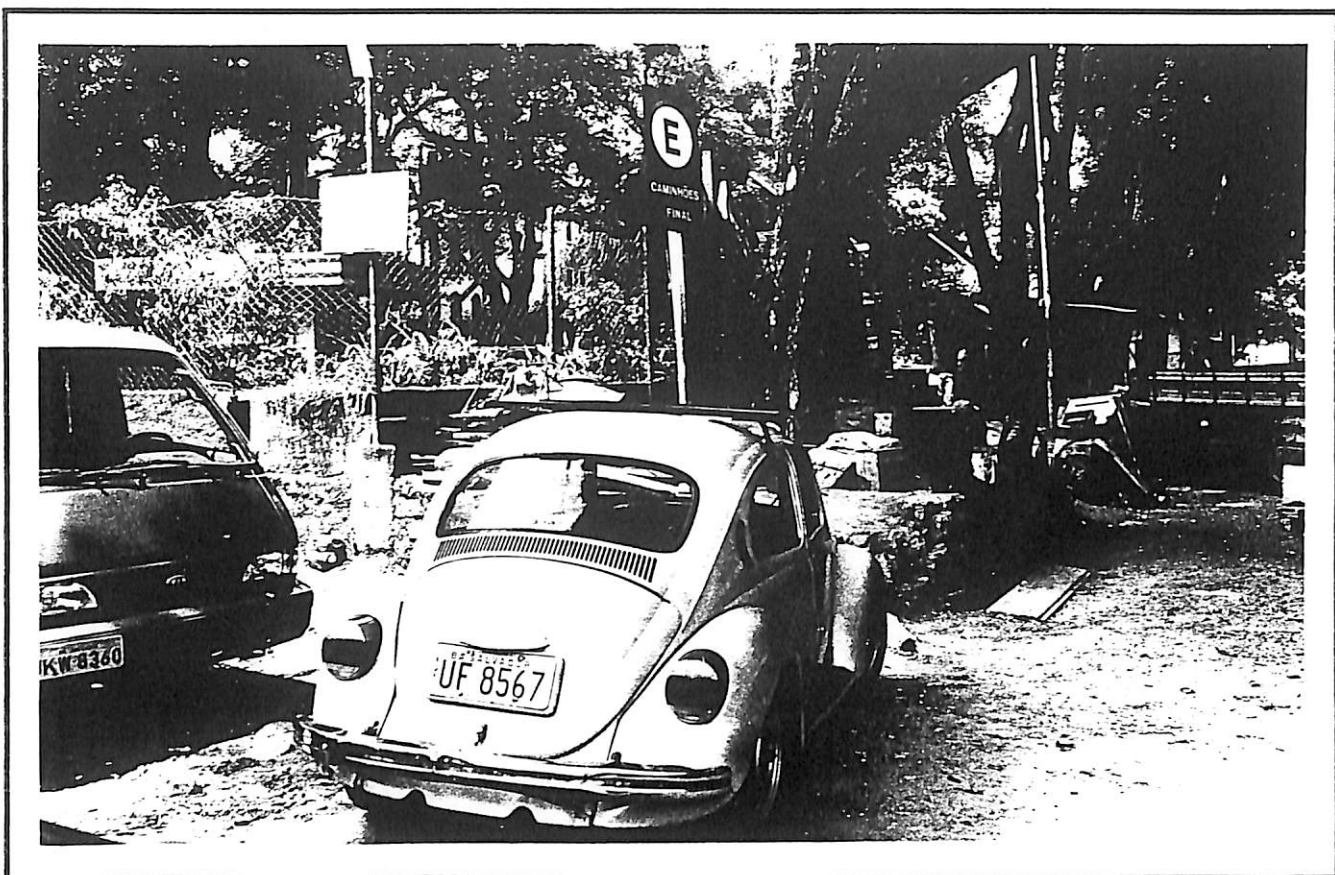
Estado de conservação da calçada e muro do estacionamento Bahia Park.
